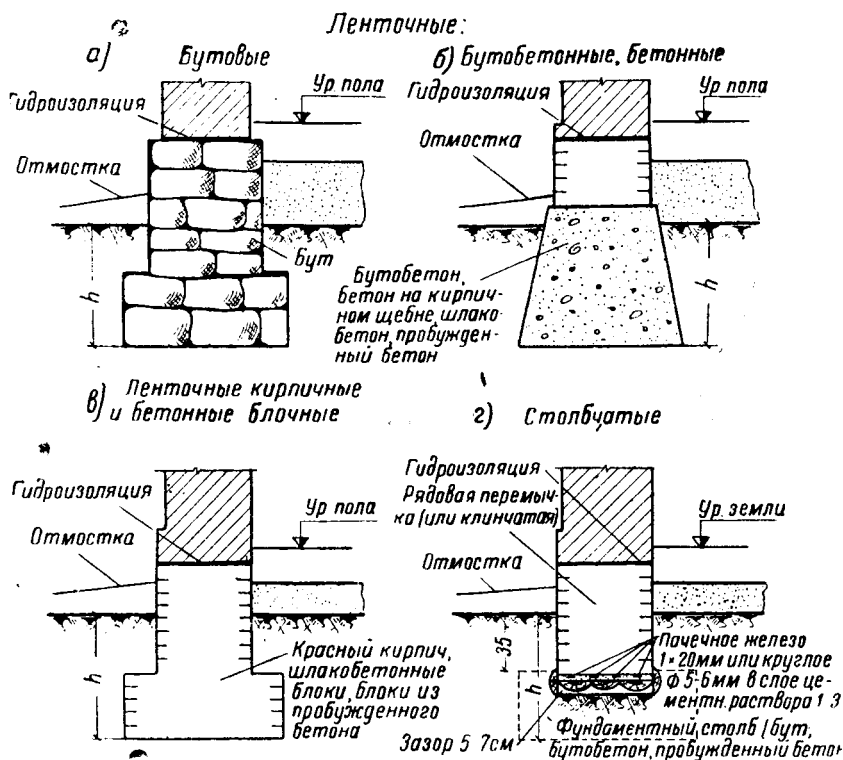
Фундаменты под каменные стены в непучинистых грунтах
